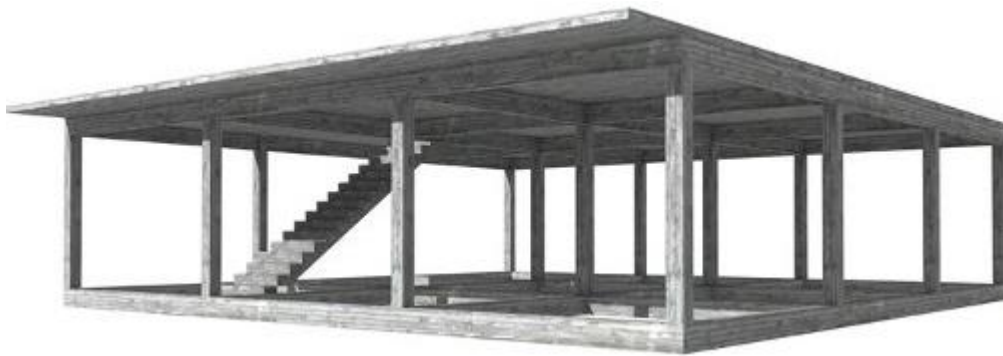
Esquema de losas, columnas y cimentación de una vivienda en hormigón armado
